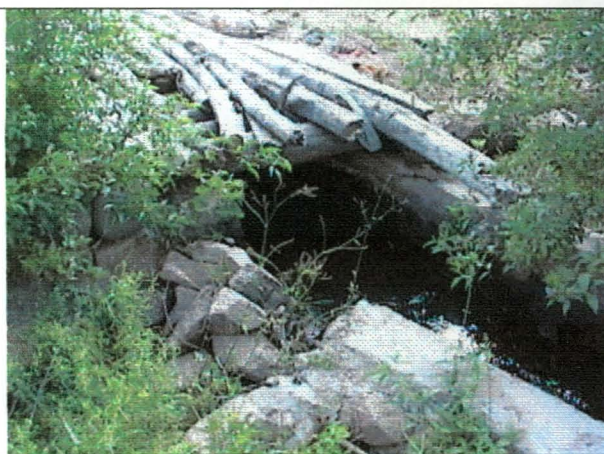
Sección Revestida de Canal La Polcura (Sin Compuerta de Entrega)
